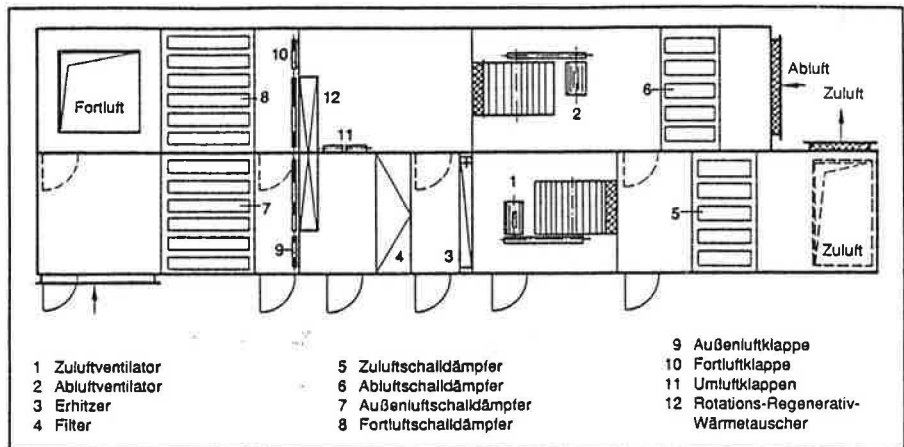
Grundriß eines Lüftungsgerätes mit Rotations-Regenerativ-Wärmetauscher für Aufstellung in Dachzentralen
